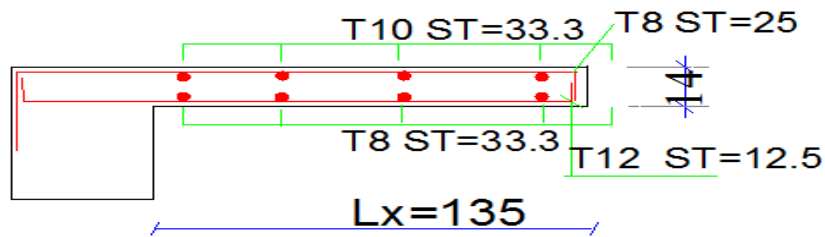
Schéma de ferrailage de la dalle sur trois appuis.
